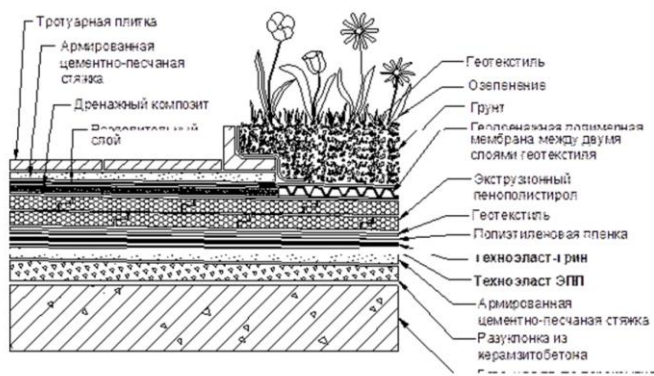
конструктивное решение инверсионной кровли с зелеными насаждениями
